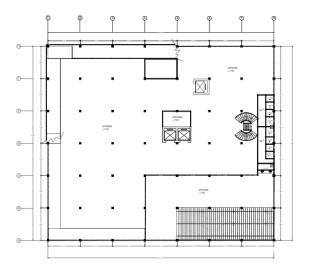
Denah Rencana Pintu Lantai 3 Sumber: dokumen pribadi
